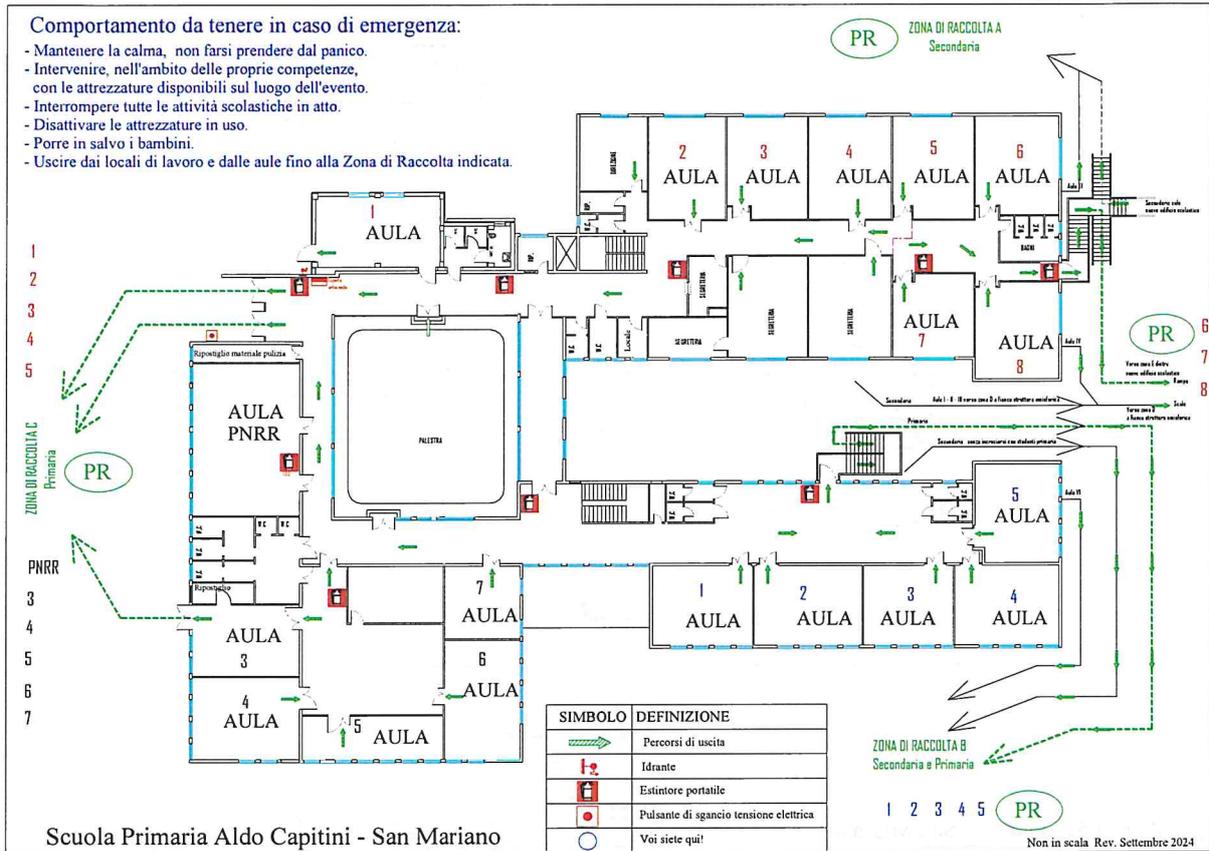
Pianta Emergenza Piano Scuola Primaria San Mariano – piano superiore
